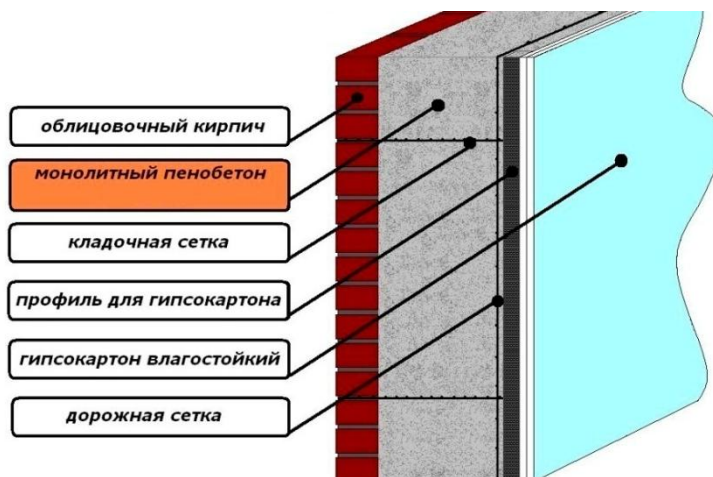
Конструкция фасада с использованием монолитного пенобетона
